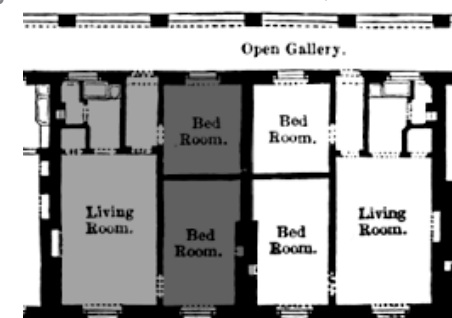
Planta tipo de una vivienda tipo "Lofty pile".
